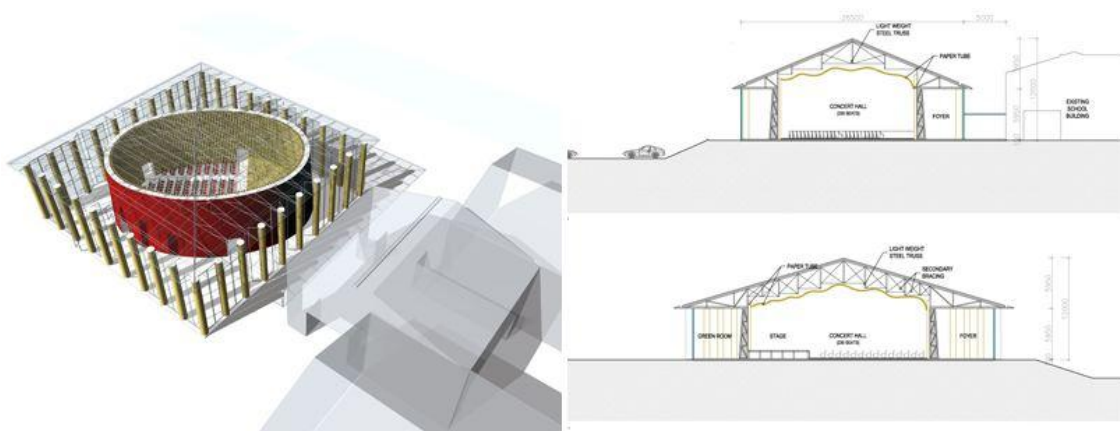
Detalhes técnicos do «Paper Concert Hall» - 'Áquila, Itália, 2010. (Shigeru Ban Architects, 2013).
